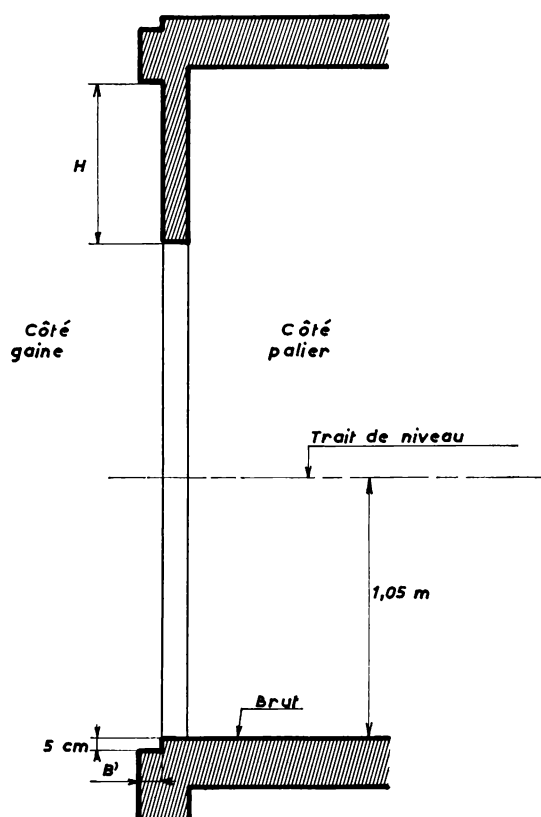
Vue en coupe de la face de la gaine pour implantation d'une porte coulissante à deux vantaux.
